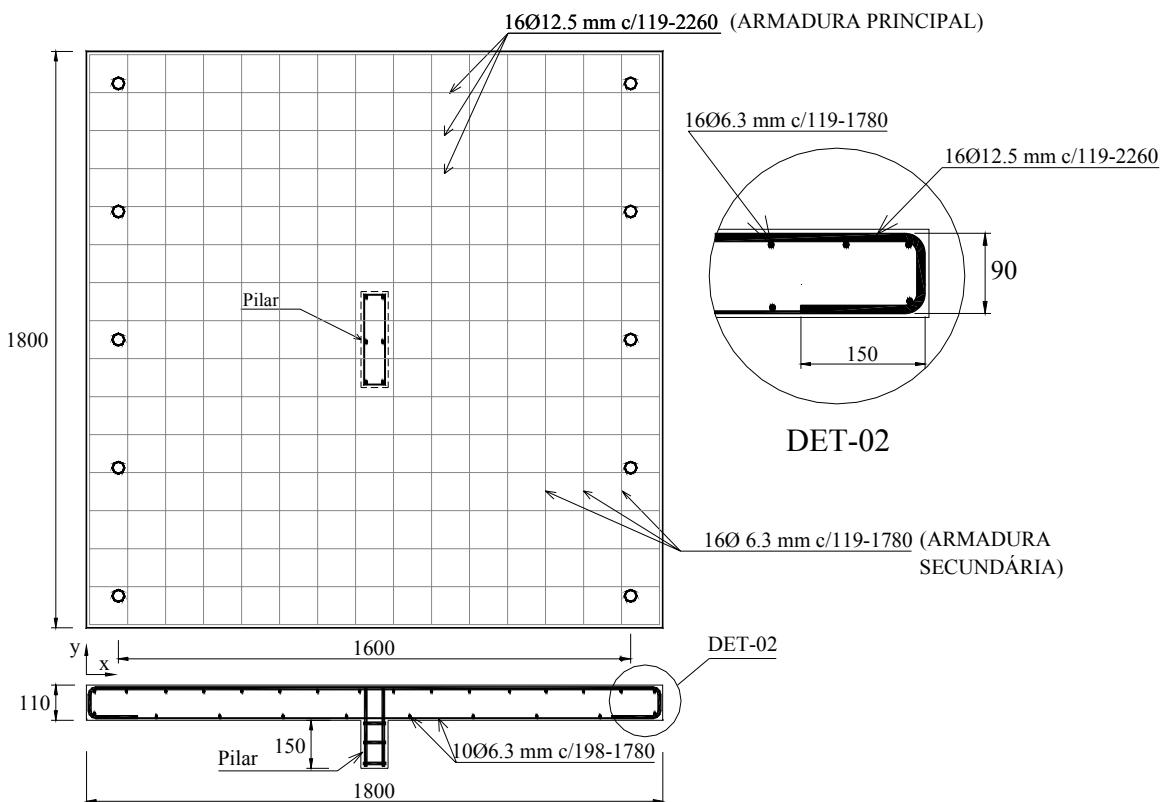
Armaduras de flexão utilizadas nas lajes L1B, L2B, L3B e L4B
